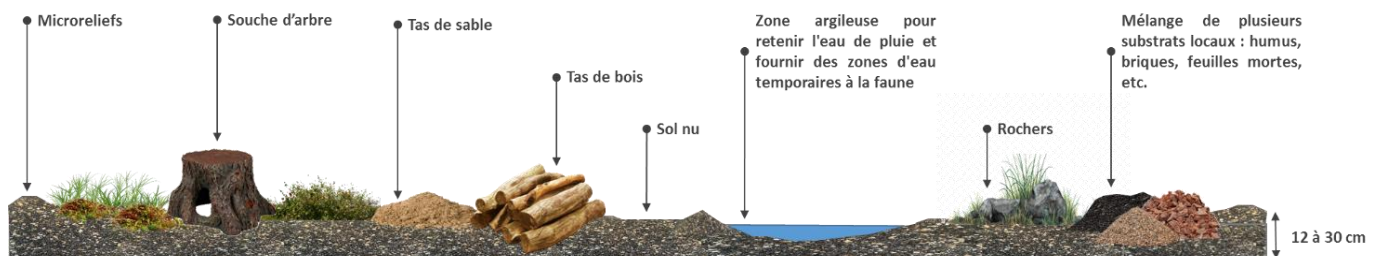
Exemple d'une coupe générale de brownroof (Source : SINTEO)
